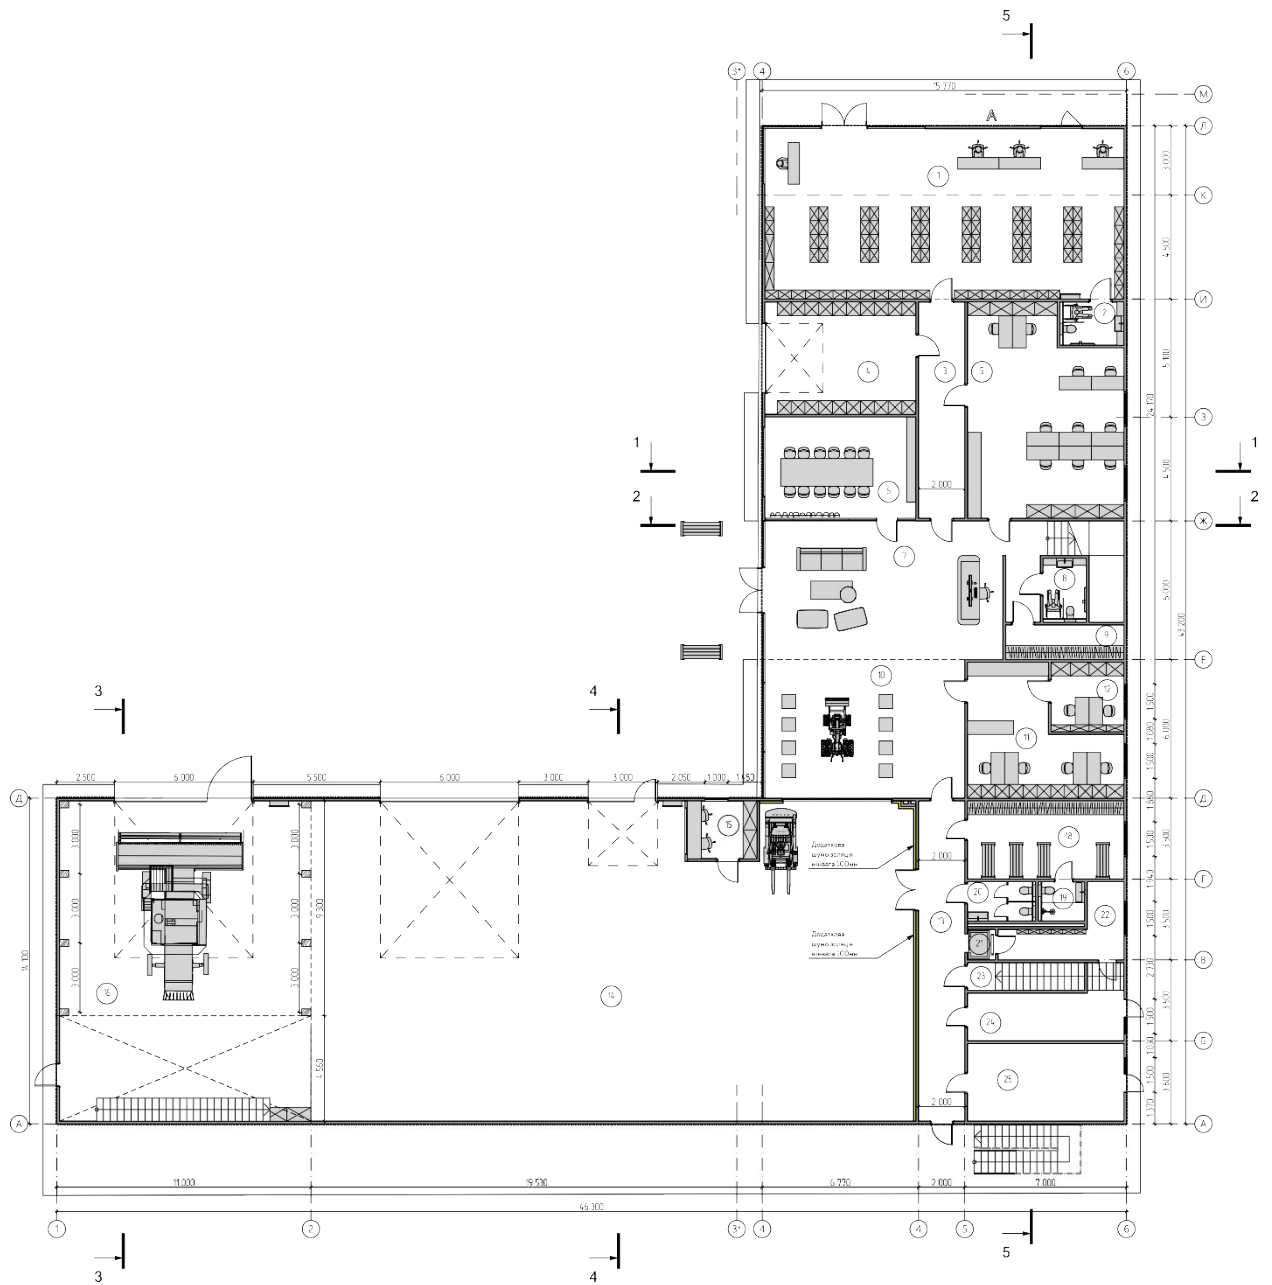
План 1-го поверху на відмітці 0,000
